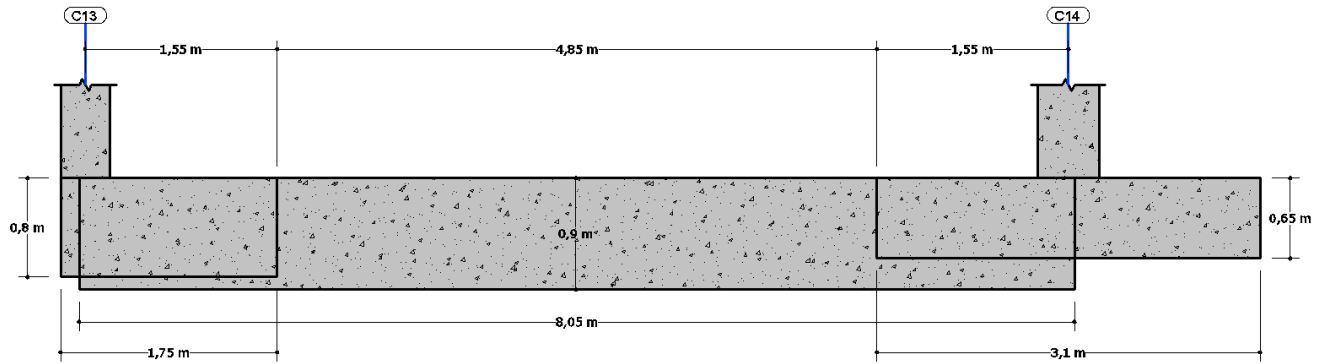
Geometria Zapata con Viga Centradora; Elaboración Propia
